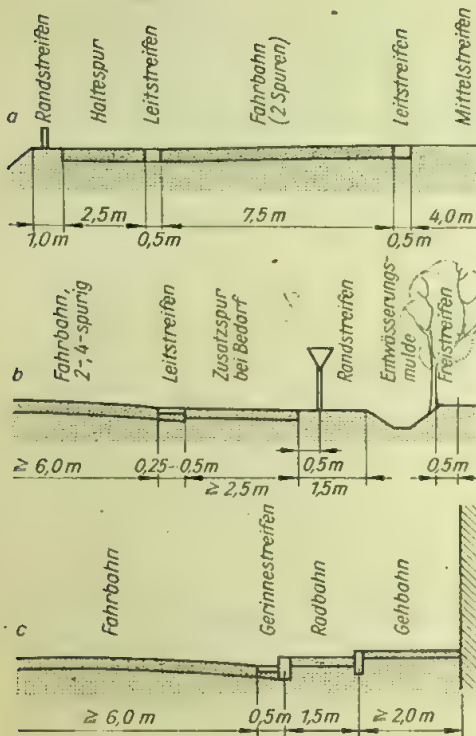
Querschnitte a einer Autobahn, b einer Landstraße und c einer Stadtstraße
